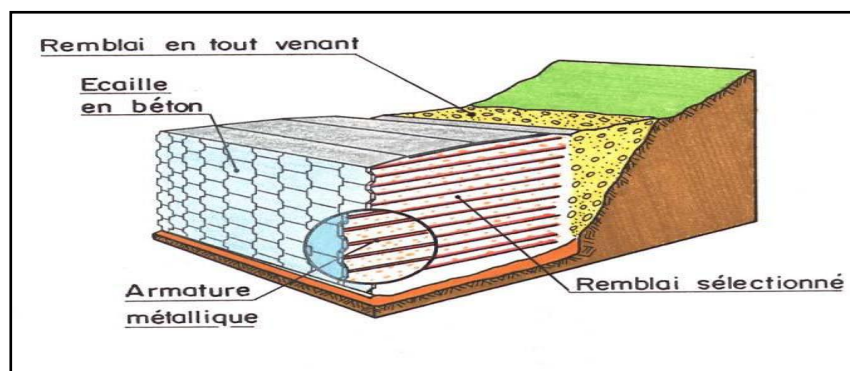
Éléments d'un mur de soutènement en Terre Armée
